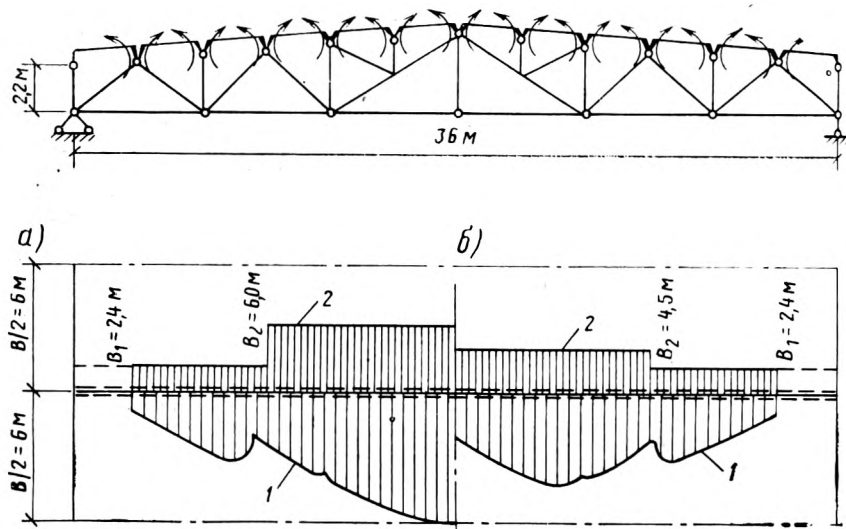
Расчетная схема сталежелезобетонной фермы для второй стадии работы
